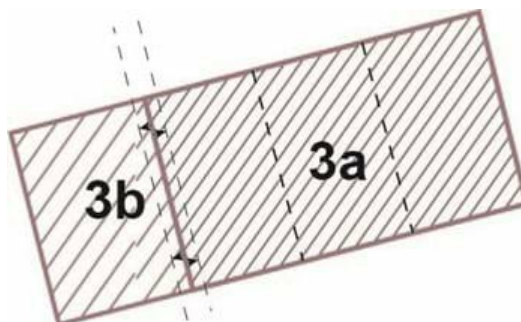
Planskitse der viser minimum omfang af forskydninger
